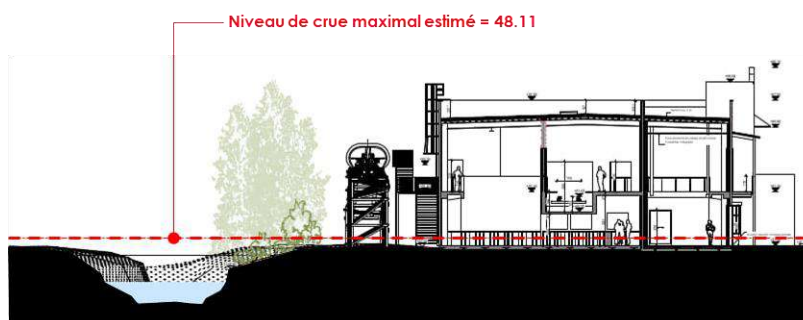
Schématisation du niveau de submersion maximal au droit du projet – Coupe transversale
